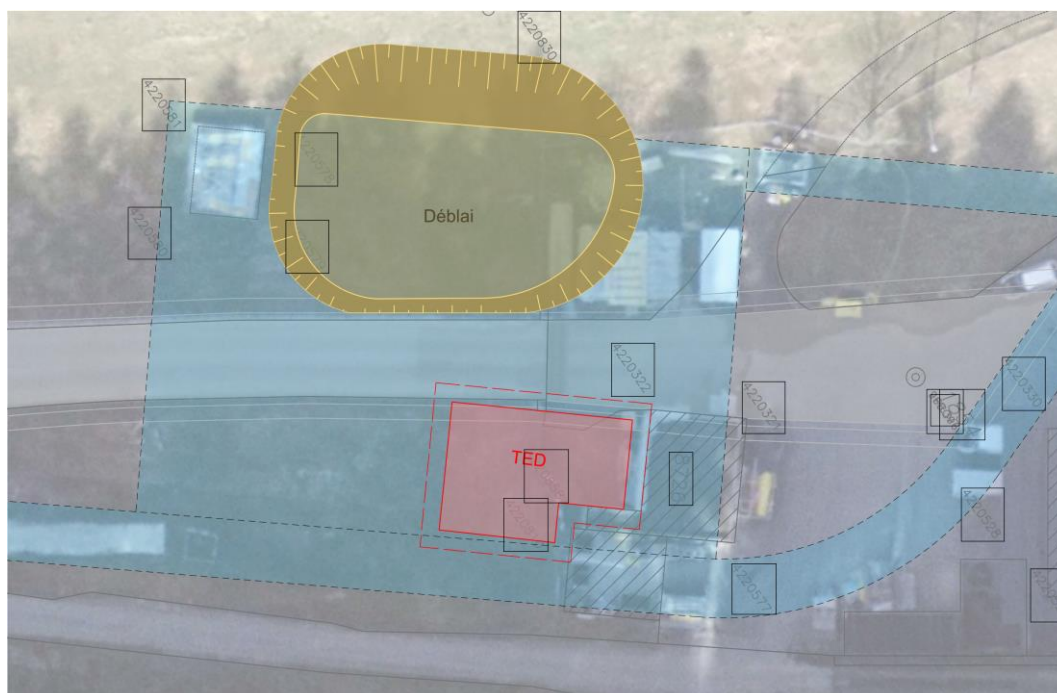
Vue en plan du projet de mise en conformité de la dalle de couverture du BEP (projet connexe de TED en rouge).
